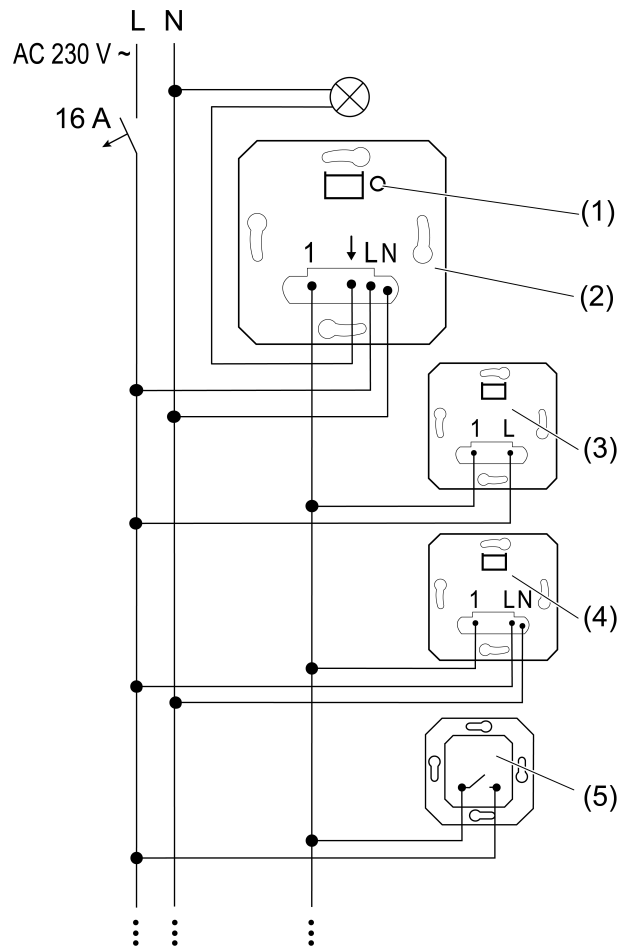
Plan de conexión con mecanismos auxiliares opcionales
